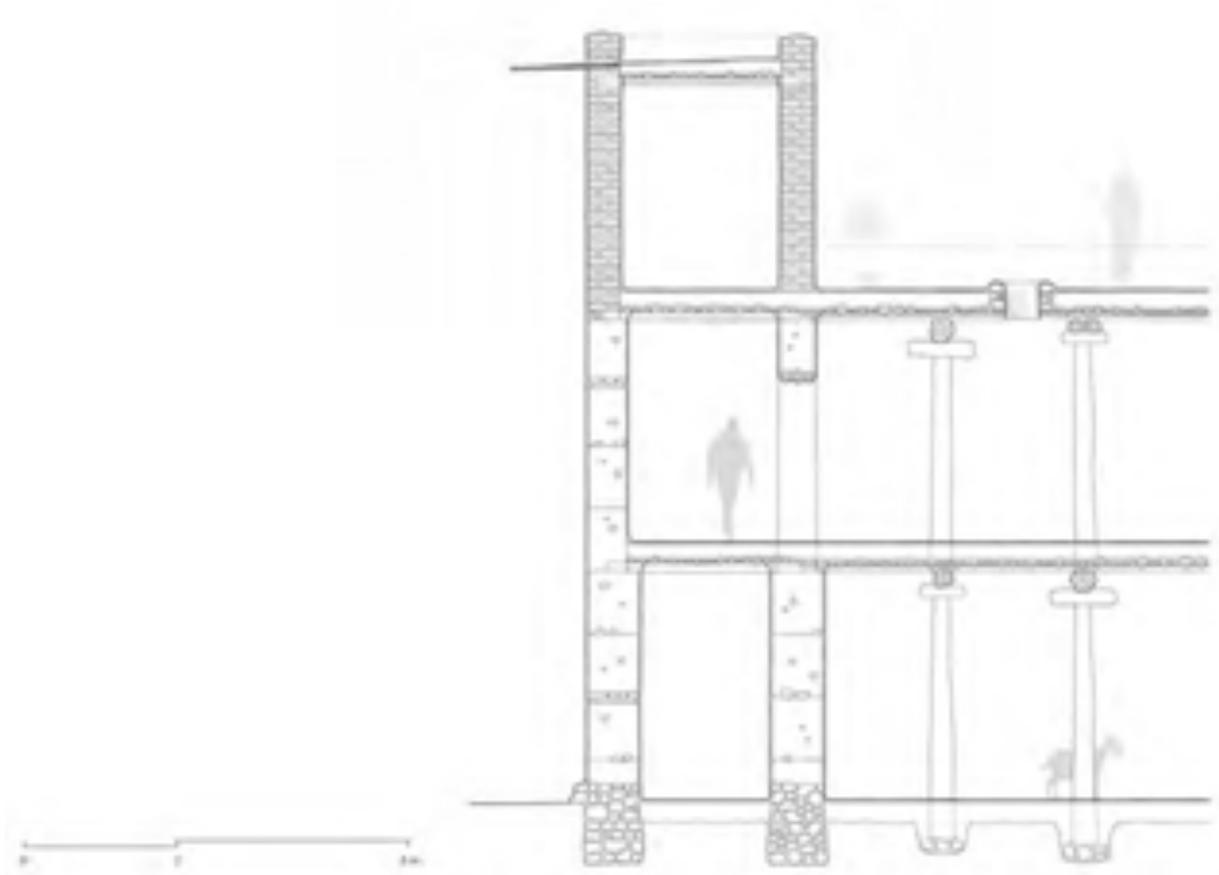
Sección constructiva del ksar de Tabenaâtout (O-19WP). Valle del Outat.
